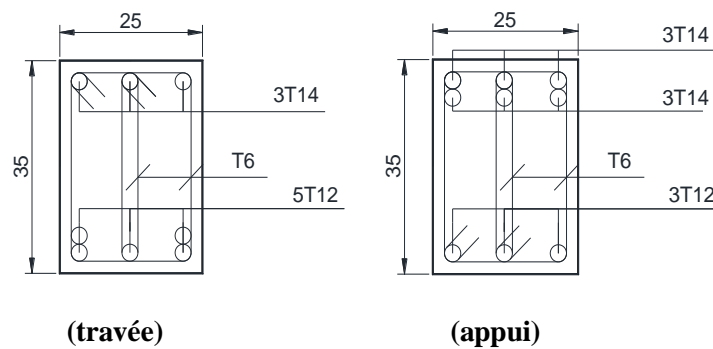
Ferrailage d'une poutre principale 25x35cm (bâtiment R+7)
